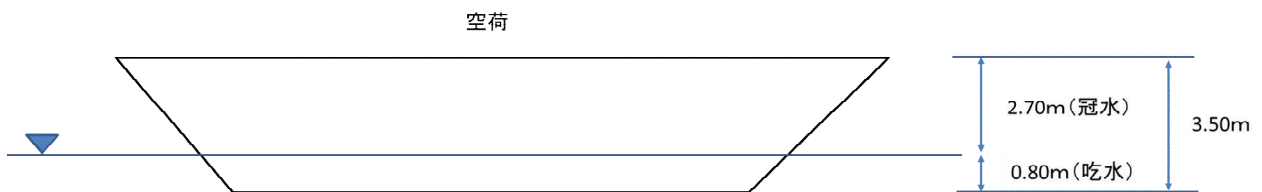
(参考 - 1) 土運船吃水確認写真 (空荷状態) イメージ図
